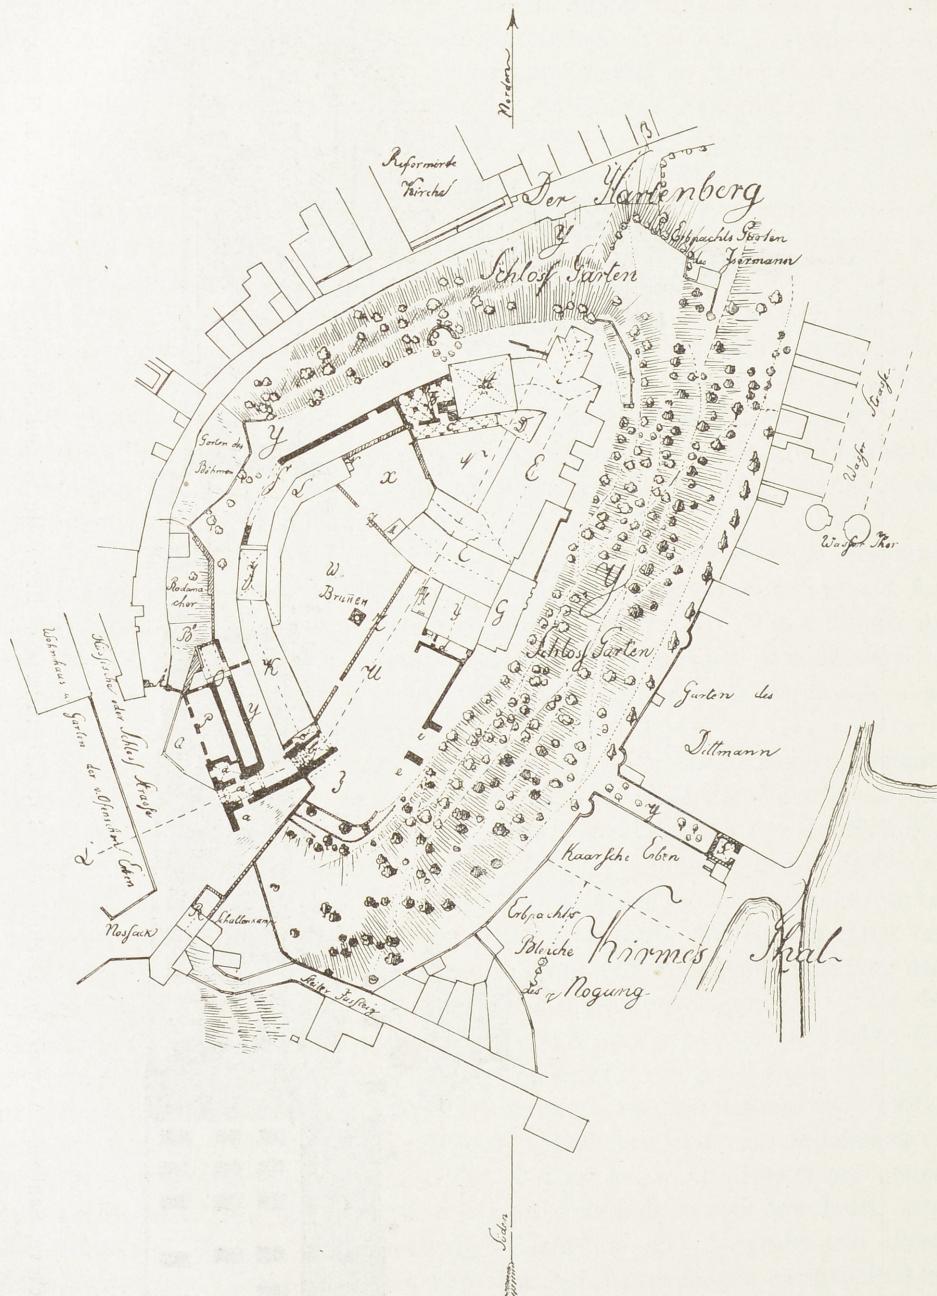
Cleve, Schloss. Lageplan aus dem Jahre 1815.
